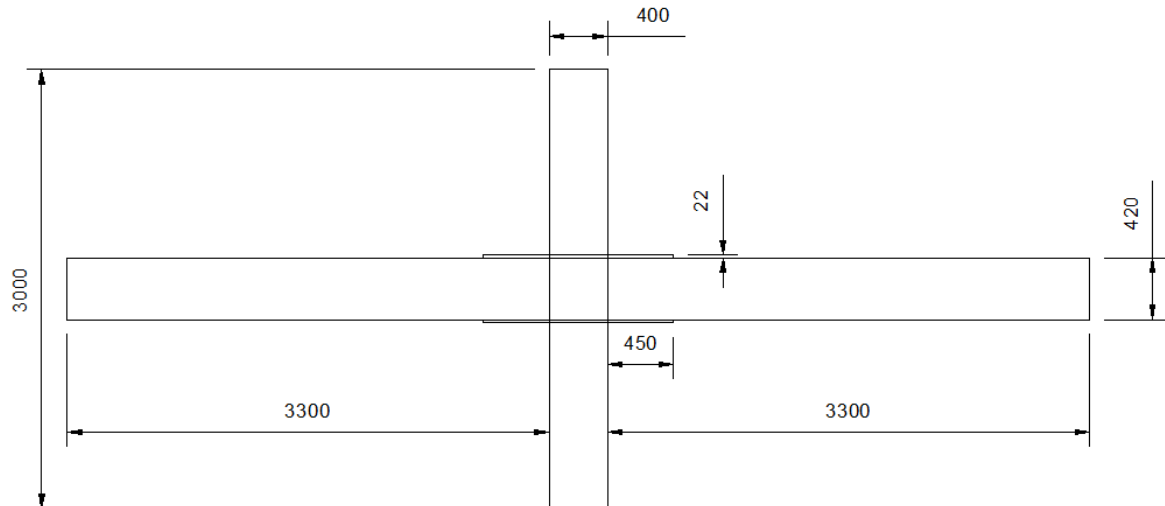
Vista frontal de la conexión viga tubular-columna tubular rectangular compuesta con diafragma externo. (Dimensiones en *mm*)
